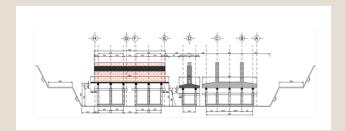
Colocación final de los marcos debajo de las zapatas de cimentación.
